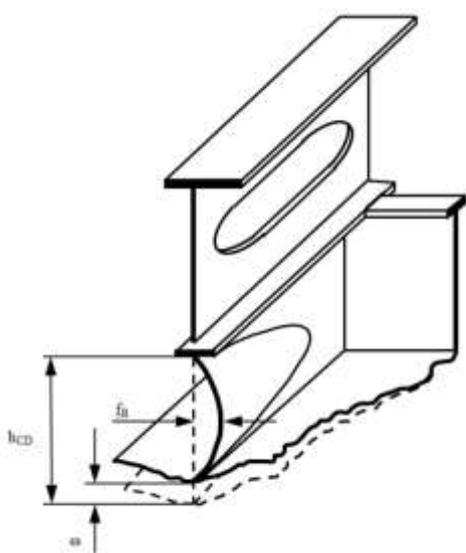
Установка дополнительной тавровой балки на свободный пояс тавровой балки с выпучиной стенки
